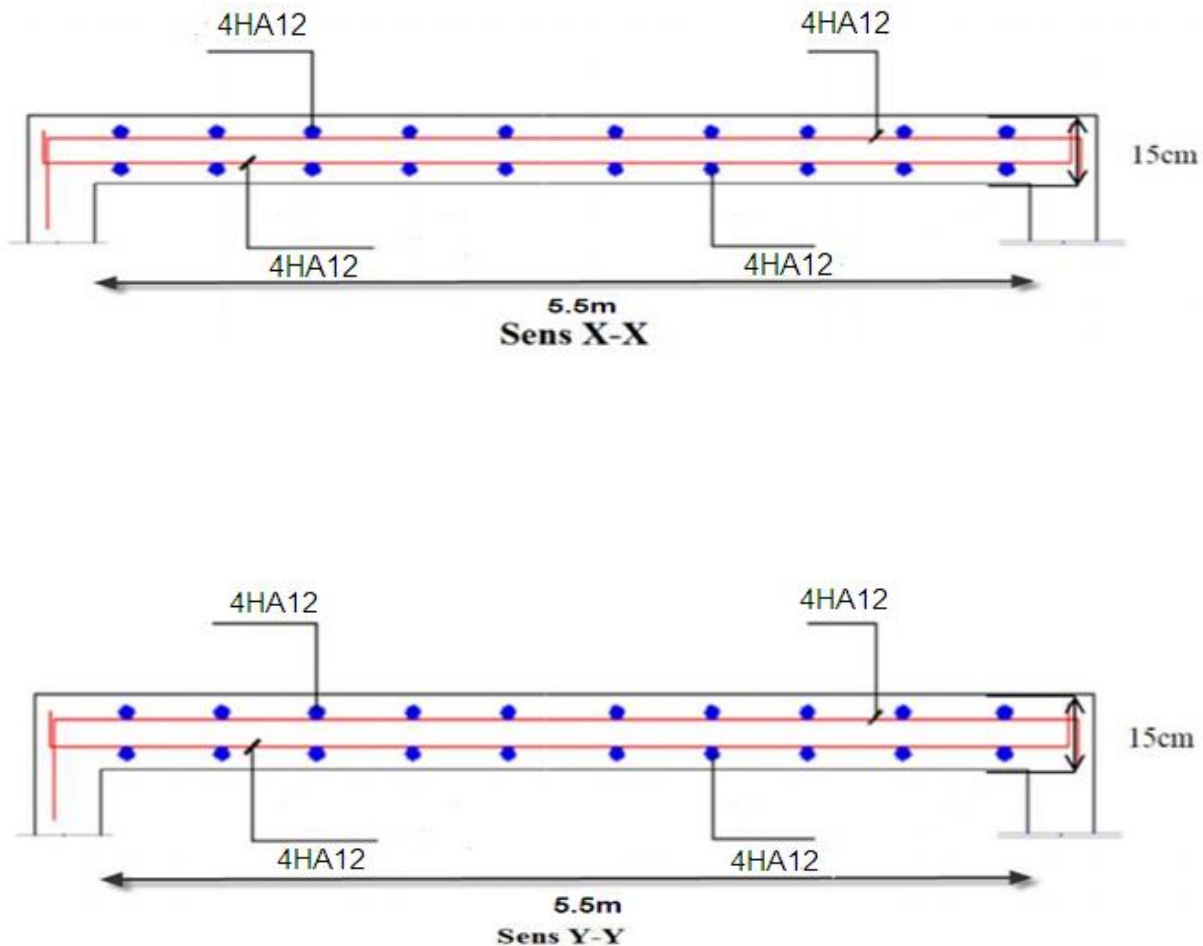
Fig III: Schéma de ferrailage Dalle pleine dans les deux directions (XX-YY)
